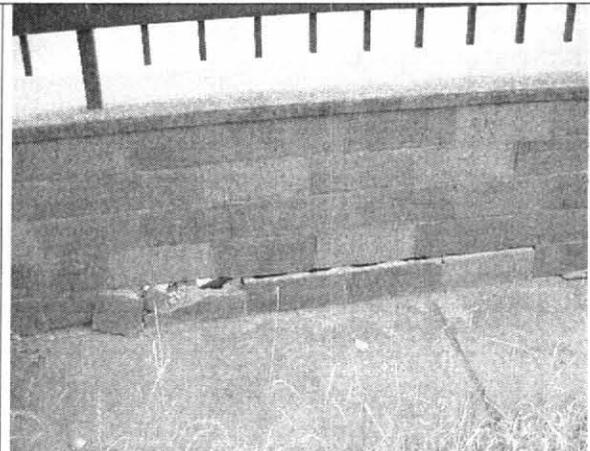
Vista interna del muro en el mismo punto de la foto 7.
